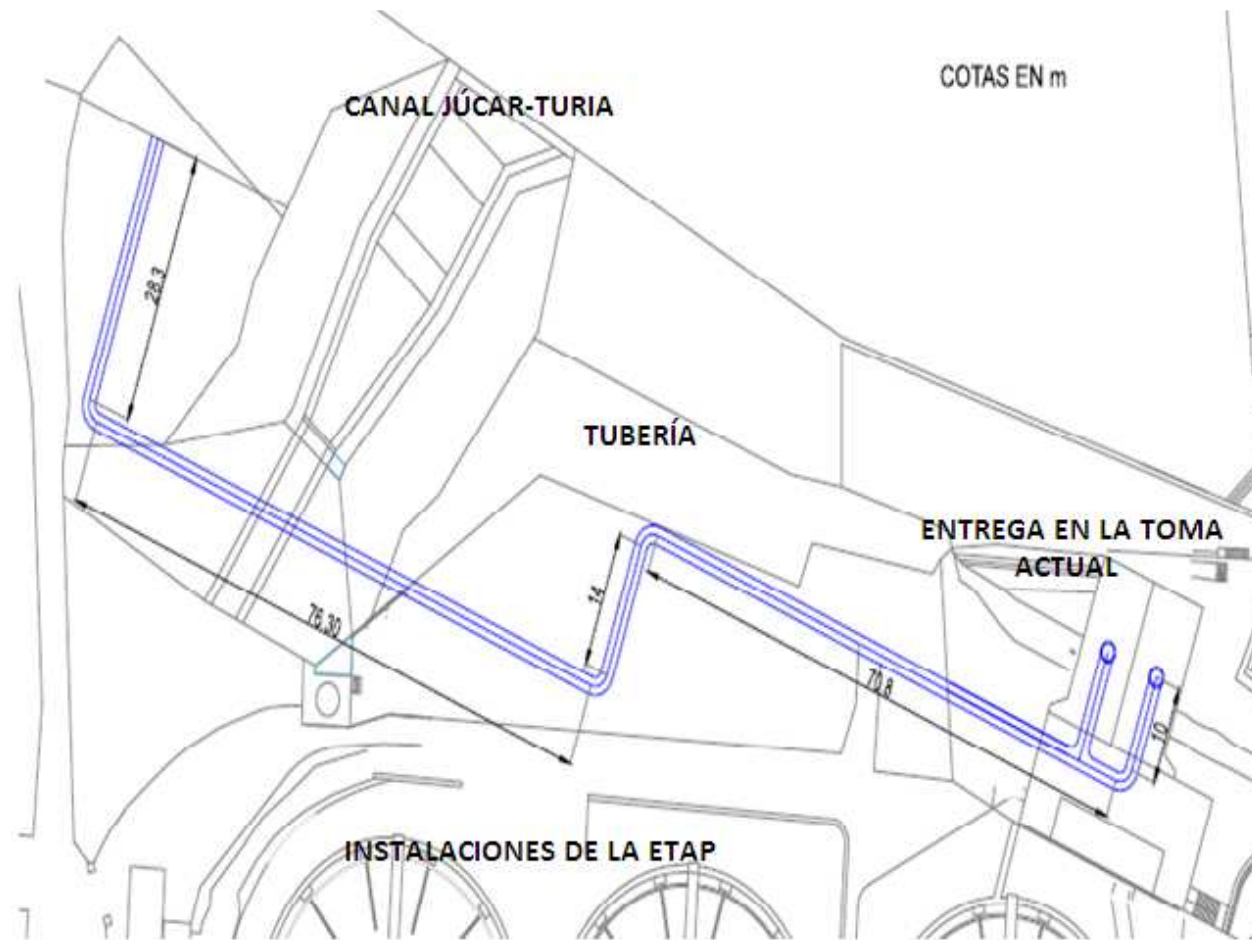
Detalle en planta de la entrega de la Alternativa 2.
